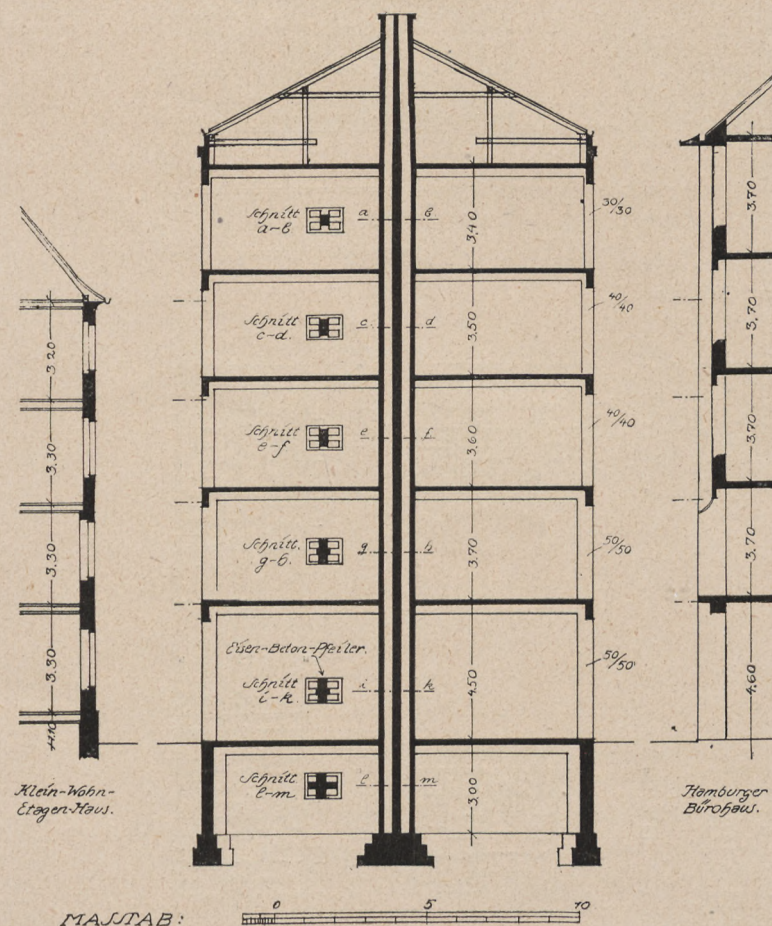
Fünfgeschossiges Reihenhauses in Eisenbeton. Querschnitt.
